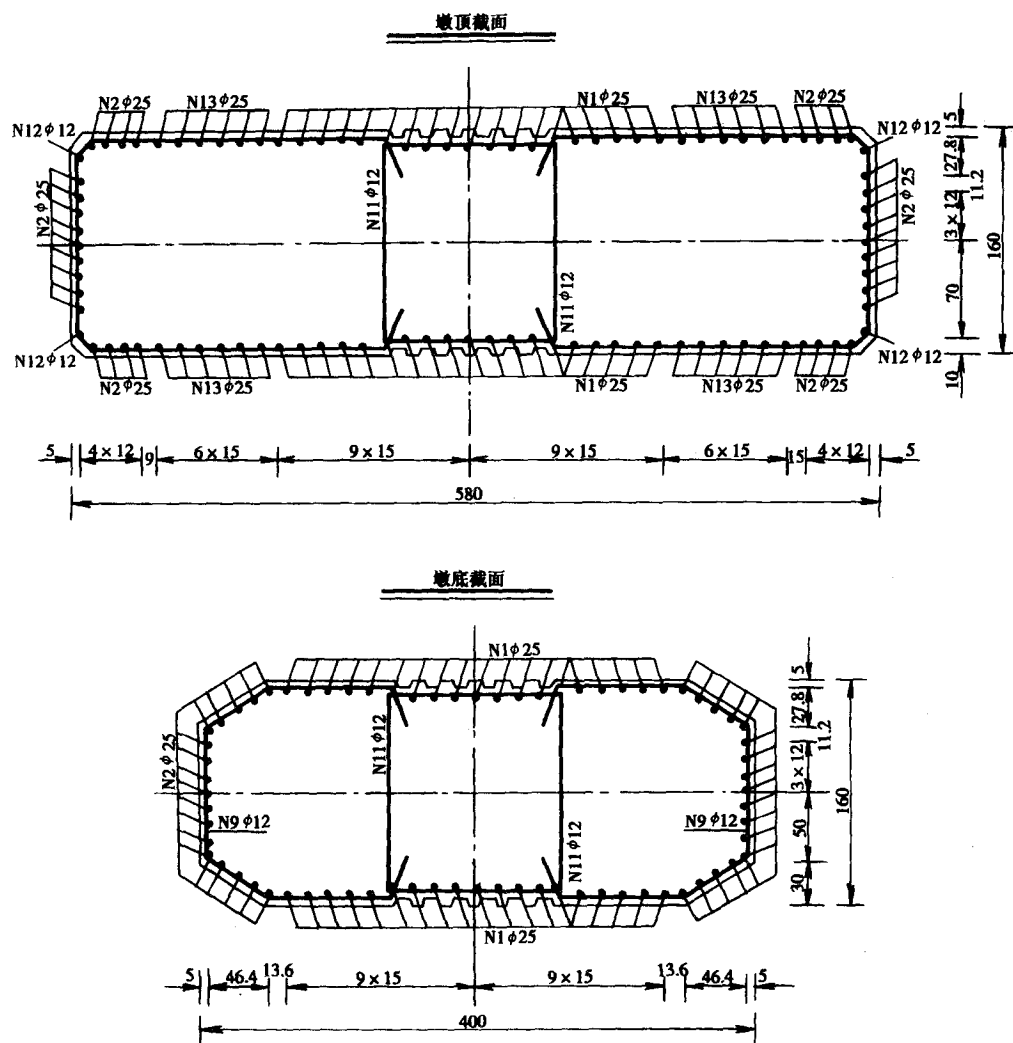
36 号墩顶和墩底截面配筋图 (尺寸单位 :mm)
